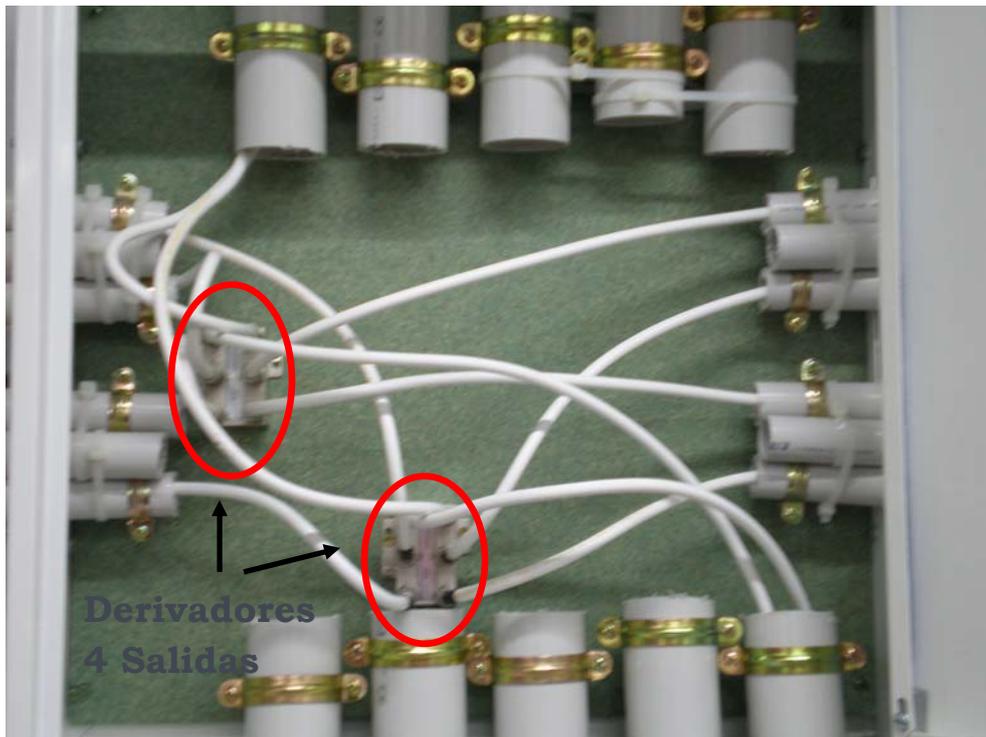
Interior de un registro secundario de una planta de 4 viviendas
